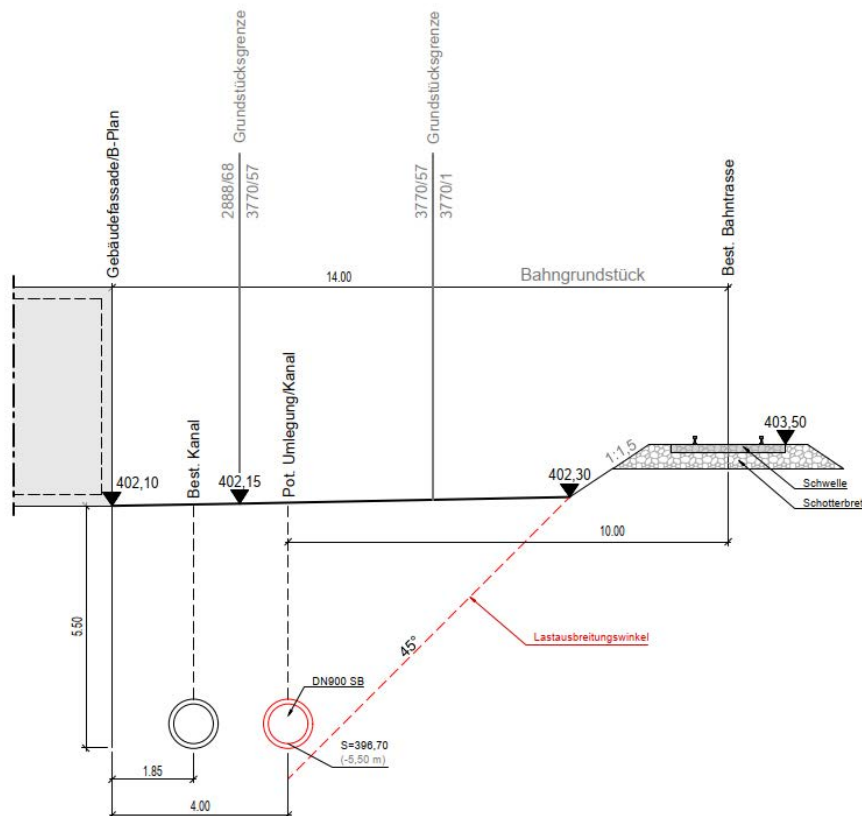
Schnitt – Abstandsprüfung Bebauungsplan zum Bestandskanal (Breinlinger Ingenieure)
